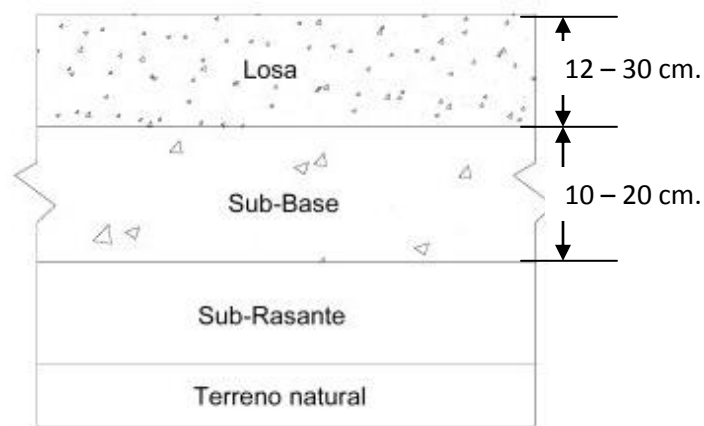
Sección transversal típica de un pavimento rígido (sección en balcón)
